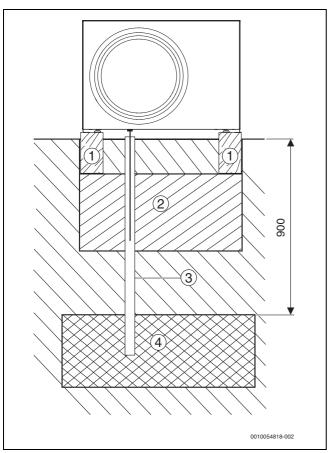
Scarico della condensa nel letto di ghiaia (dimensioni in mm)
